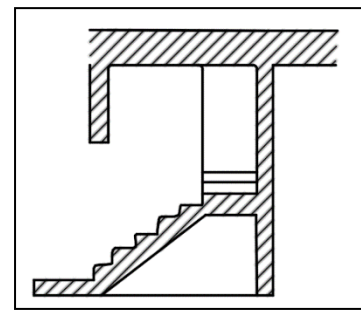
escaiers sur poutres de palmier. Source : fait par l'auteur
